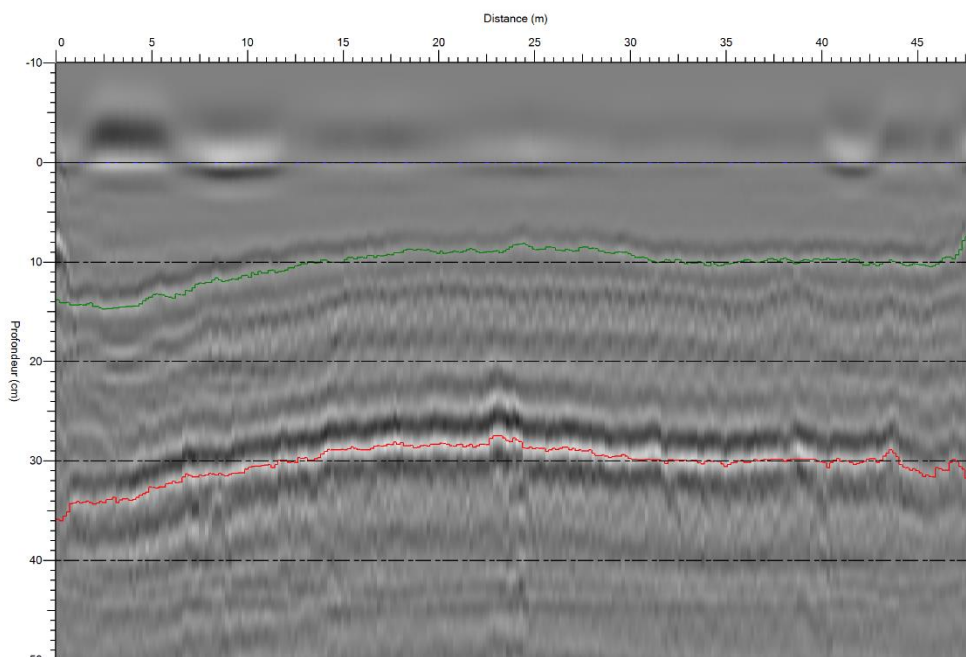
Voie rapide en direction de Sedan (ouvrage PI1), l'interface verte correspond à la base de l'enrobé, l'interface rouge correspond à la base de la dalle béton.
